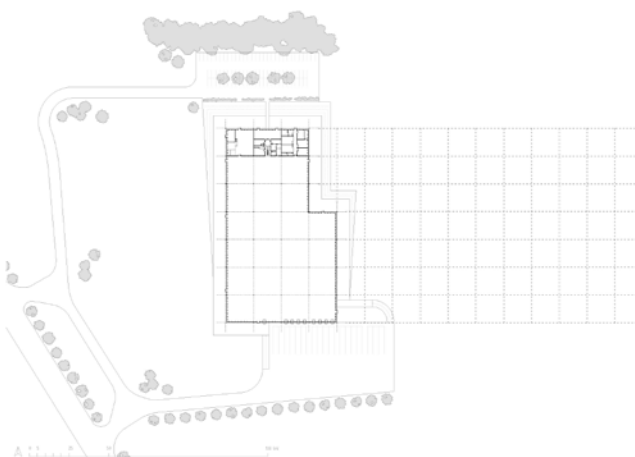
Planta de la distribución interior de la fábrica Fleetguard.
